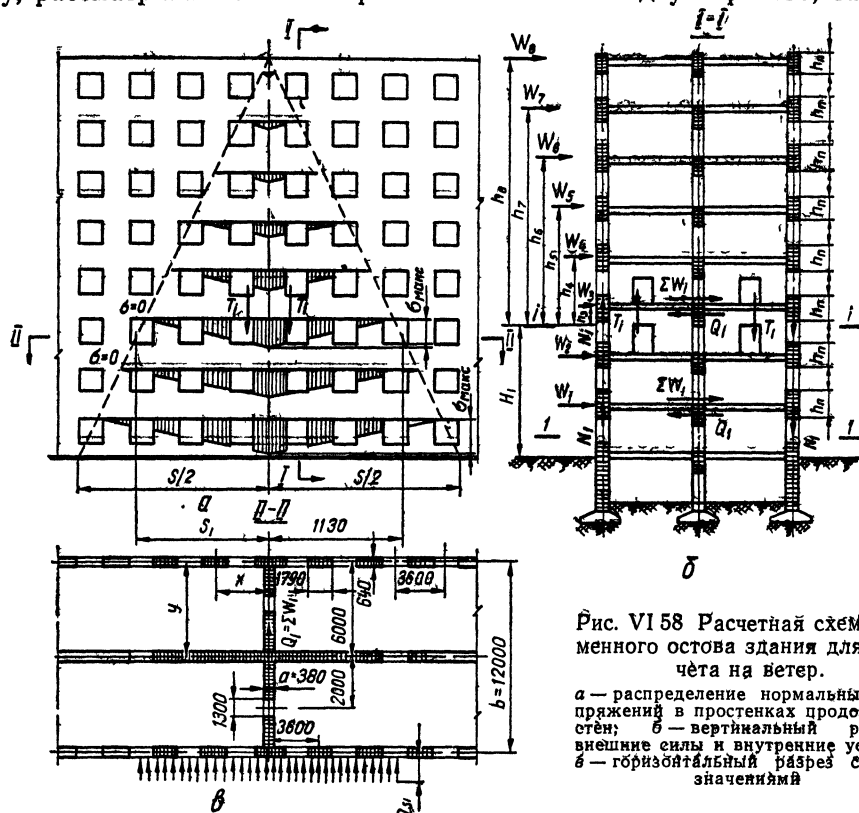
Расчетная схема каменного остова здания для расчета на ветер.
